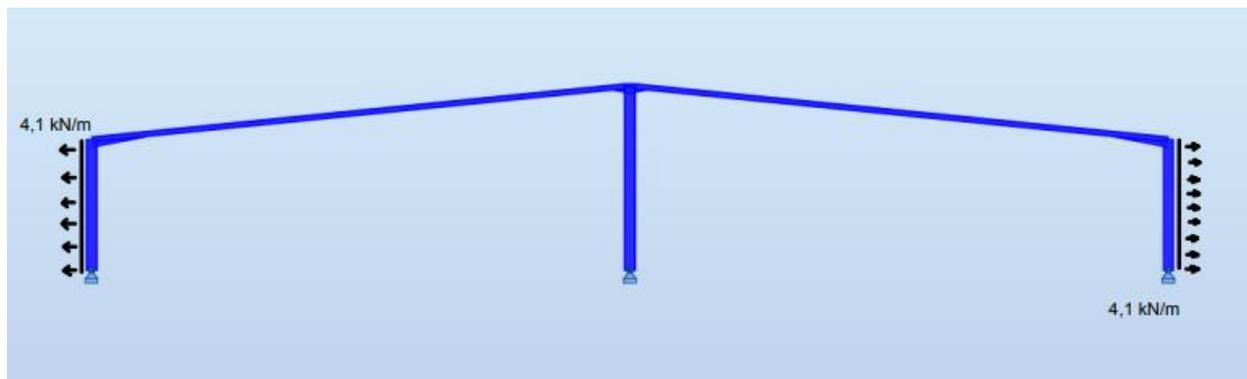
REPRESENTACIÓN CARGAS DE VIENTO EN ZONA B EN PÓRTICO INTERIOR CON DIRECCIÓN LONGITUDINAL A LA FACHADA
